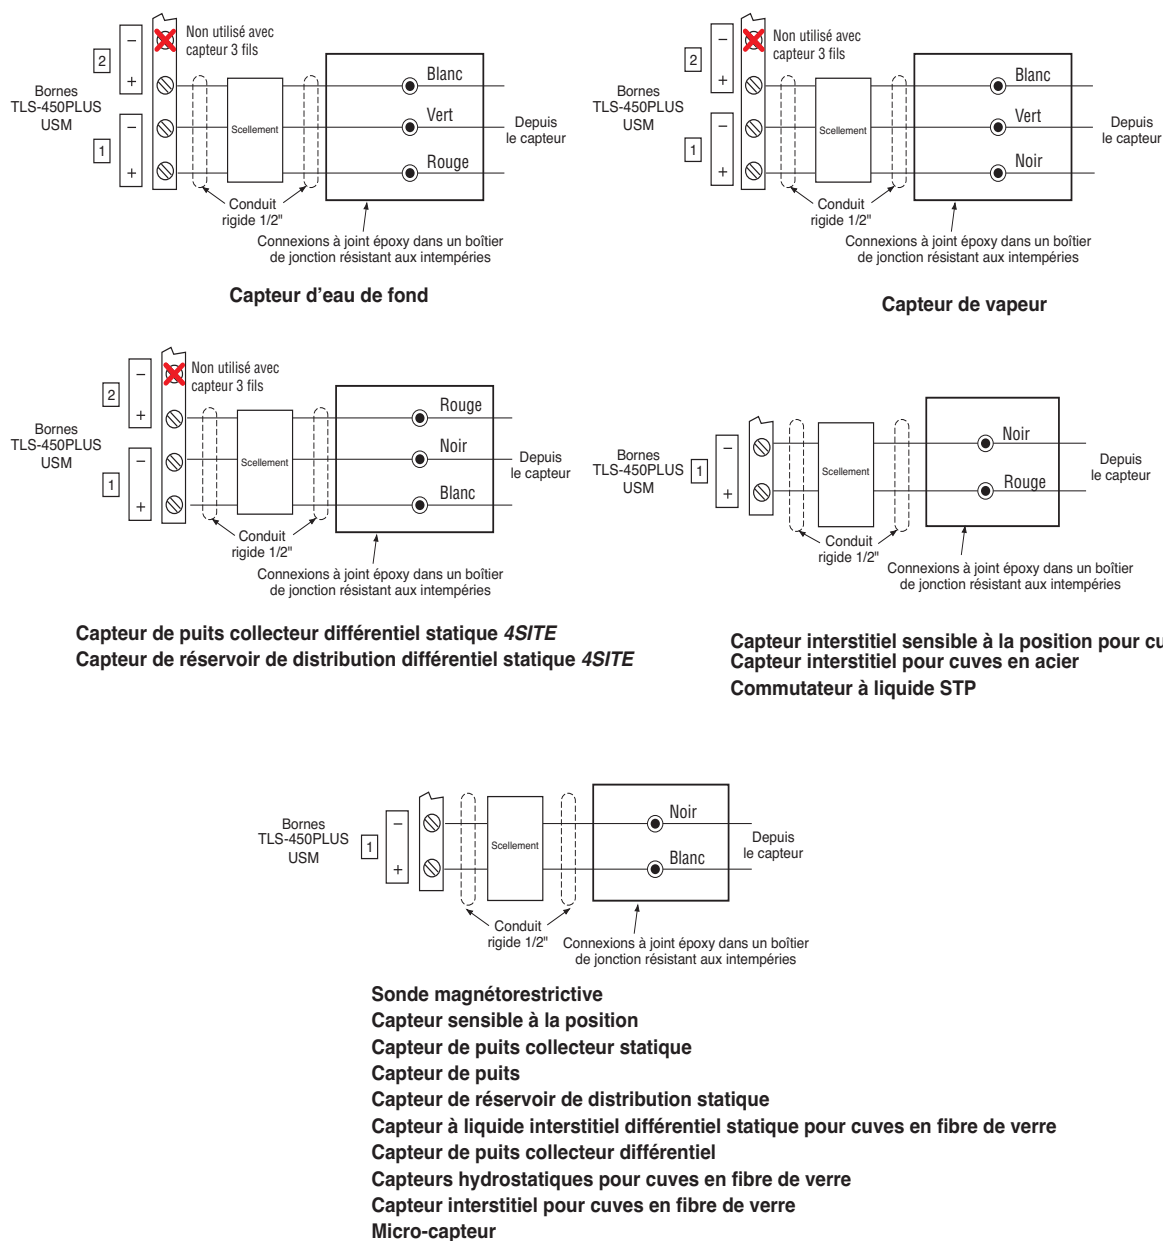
Connexion sur site des câbles provenant des sondes et capteurs aux câbles provenant de la console
